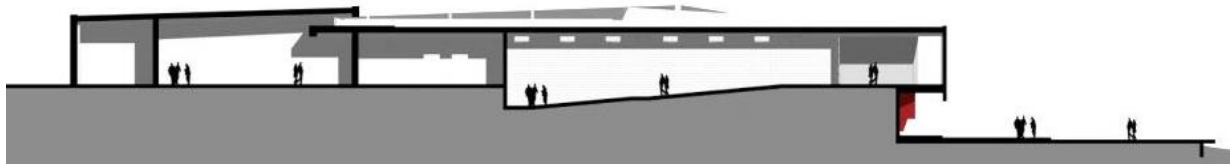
Corte transversal D-D, se observa la estructura horizontal y un área en voladizo que da hacia la plaza principal.
